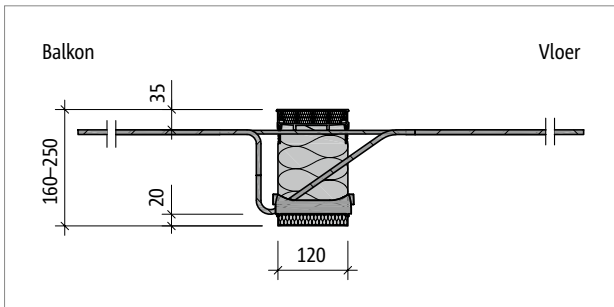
Schöck Isokorf® XT type K-E: Uitsparing detail B
